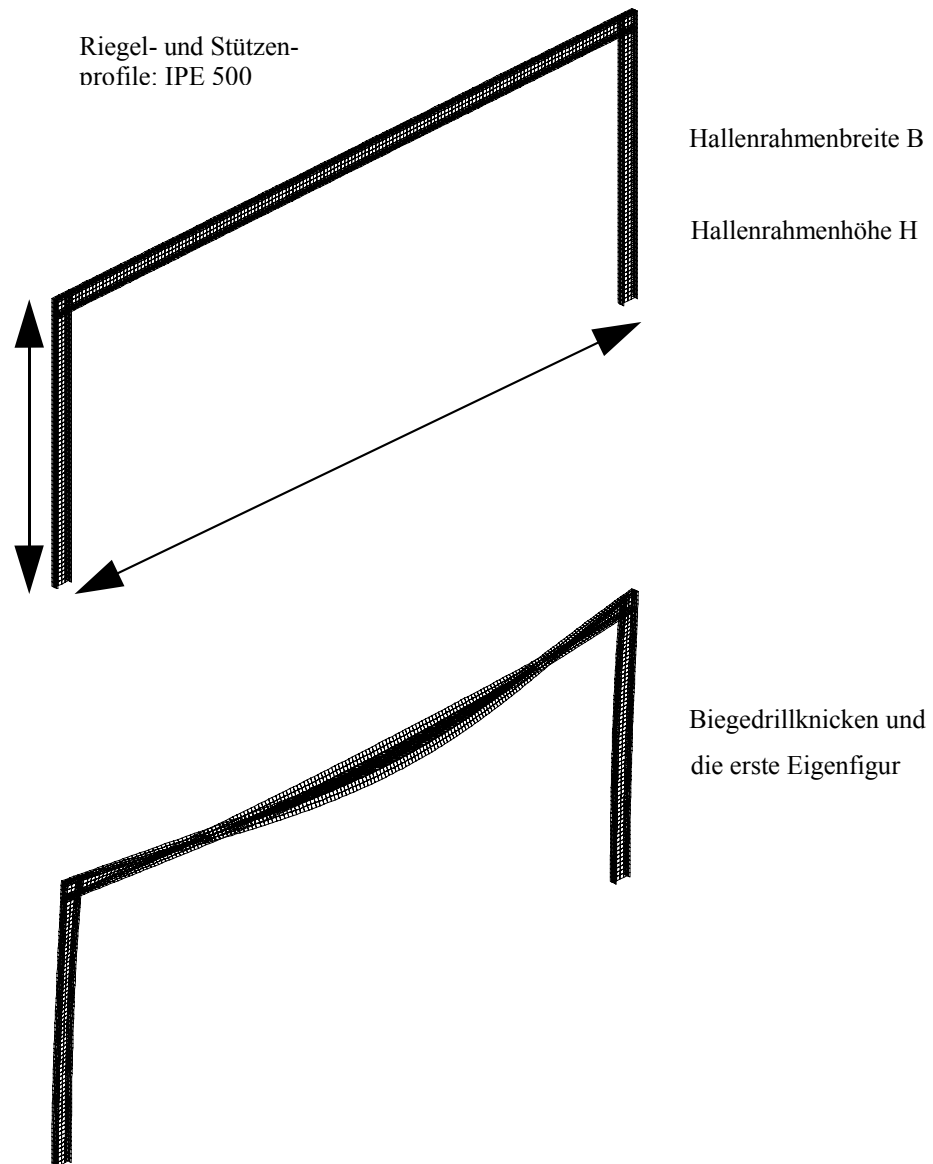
Hallenrahmen mit Flachdach und die Eigenfigur
